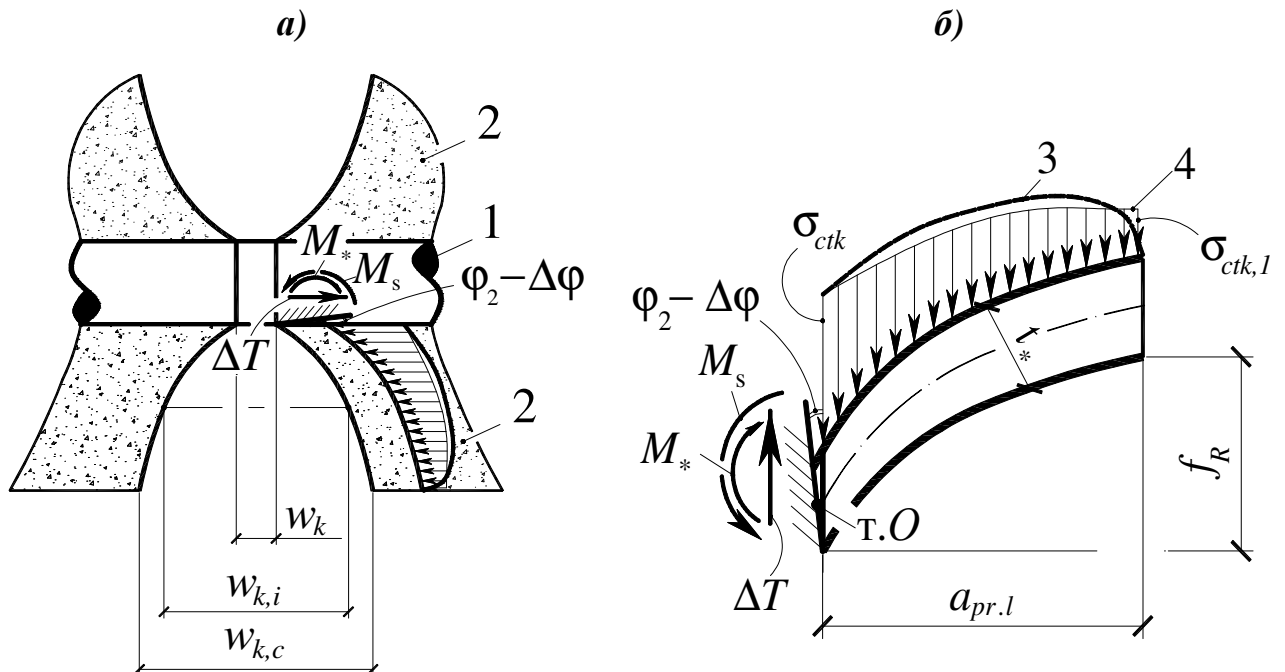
Депланація бетону в перерізі з тріщиною: а – фрагмент навколоарматурної зони залізобетонної конструкції; б – розрахункова схема для визначення переміщень берегів тріщини, виділена у зоні захисного шару;
